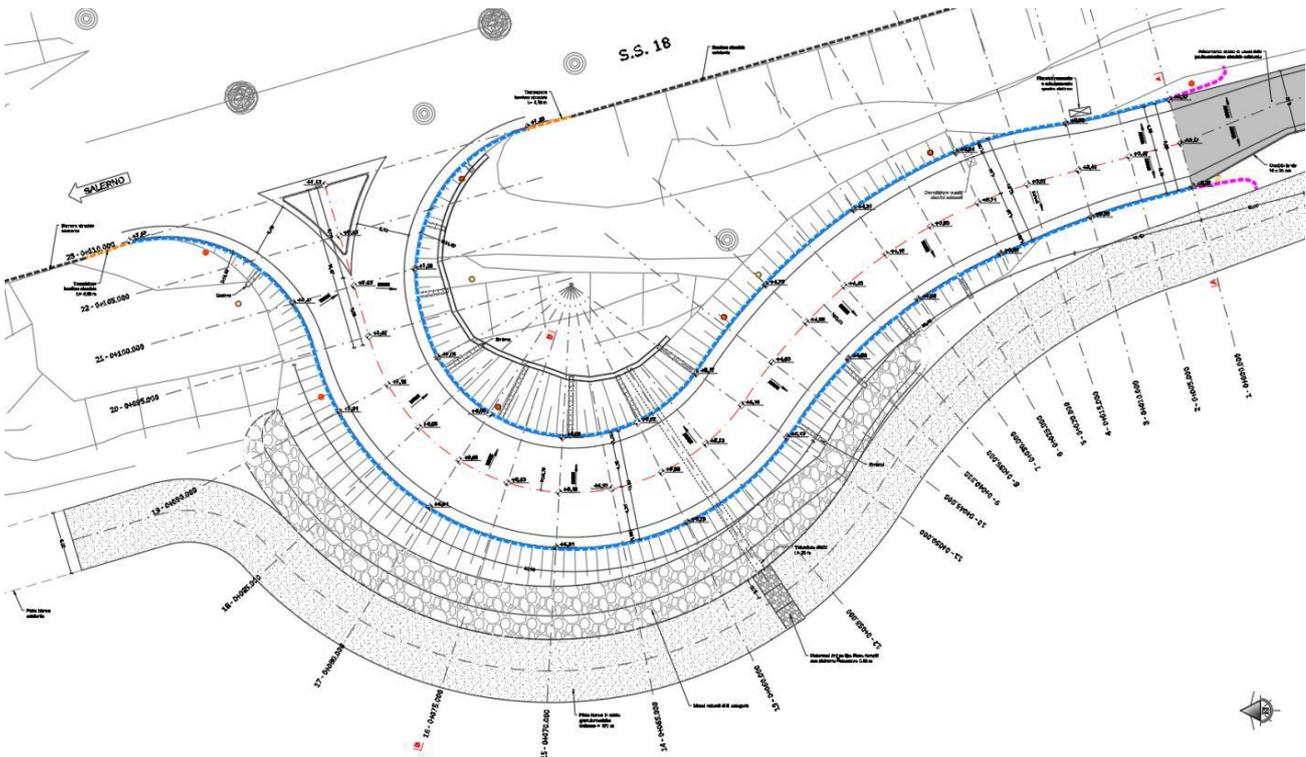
Planimetria raccordo di collegamento porto - SS18
